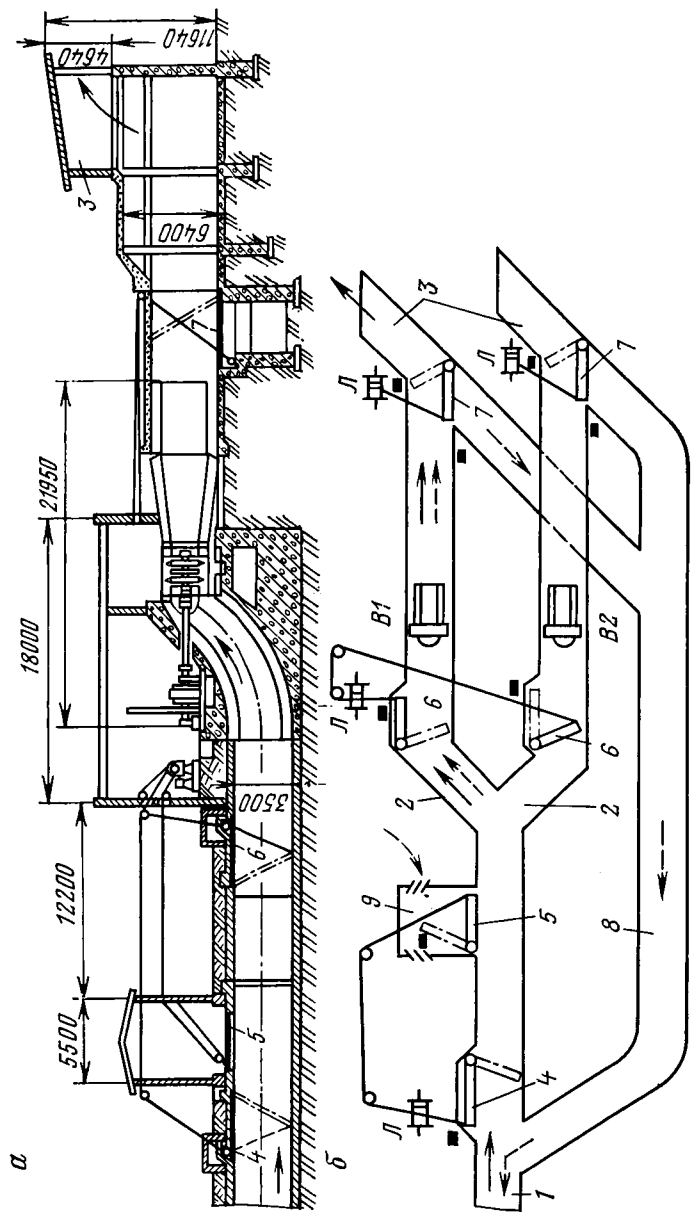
Разрез вентиляционной установки с осевым вентилятором (а) и схема реверсирования вентиляторов (б)
